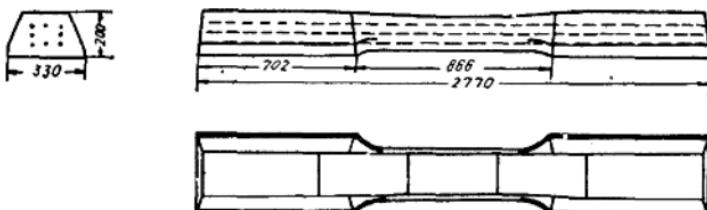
西德BS—55型整体先张粗钢筋混凝土轨枕
